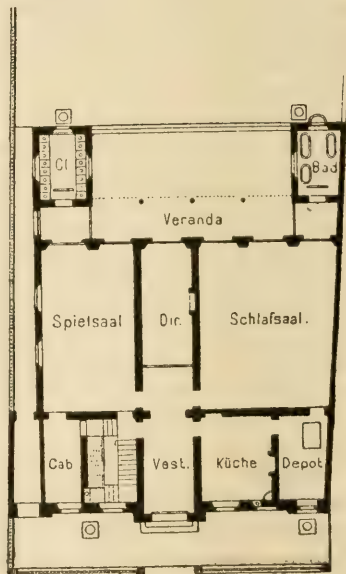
b. Grundriss des Erdgeschosses.
